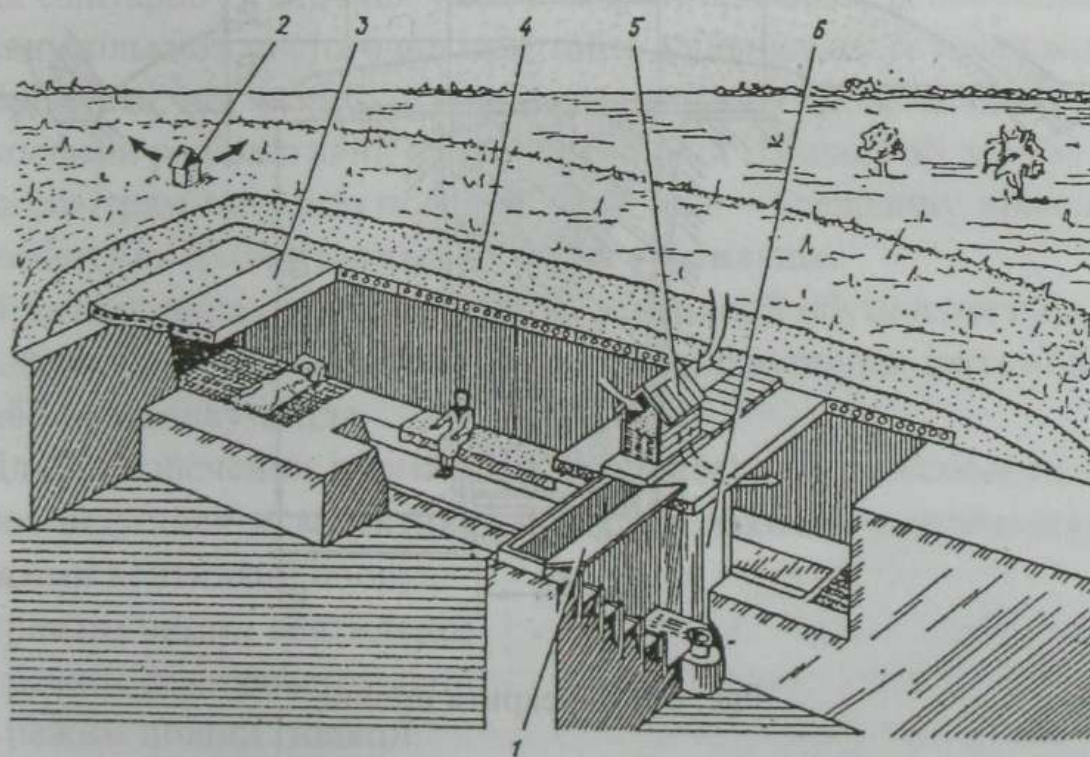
Протирадіаційне укриття з перекриттям із залізобетонних плит:
